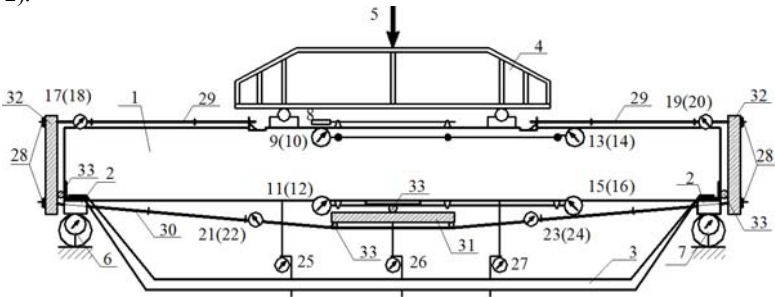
Схема випробування залізобетонних балок, підсилені ВСС, де 1 – експериментальна балка; 2 – опори балки; 3 – рамка для прогиномірів; 4 – розподільча траверса; 5 – напрямок дії гвинтового домкрату; 6, 7 – динамометри; 8-16 – індикатори з ціною поділки 0,001 мм для вимірювання деформацій бетону; 17-24 – індикатори з ціною поділки 0,01 мм для вимірювання деформацій затяжки та розтяжок; 25-27 – індикатори з ціною поділки 0,01 мм для вимірювання прогинів балки; 28 – комплект кріплення із сферичними шайбами; 29 – розтяжки; 30 – затяжка; 31 – траверса; 32 – двоплечові важелі.; 33 – котки.
